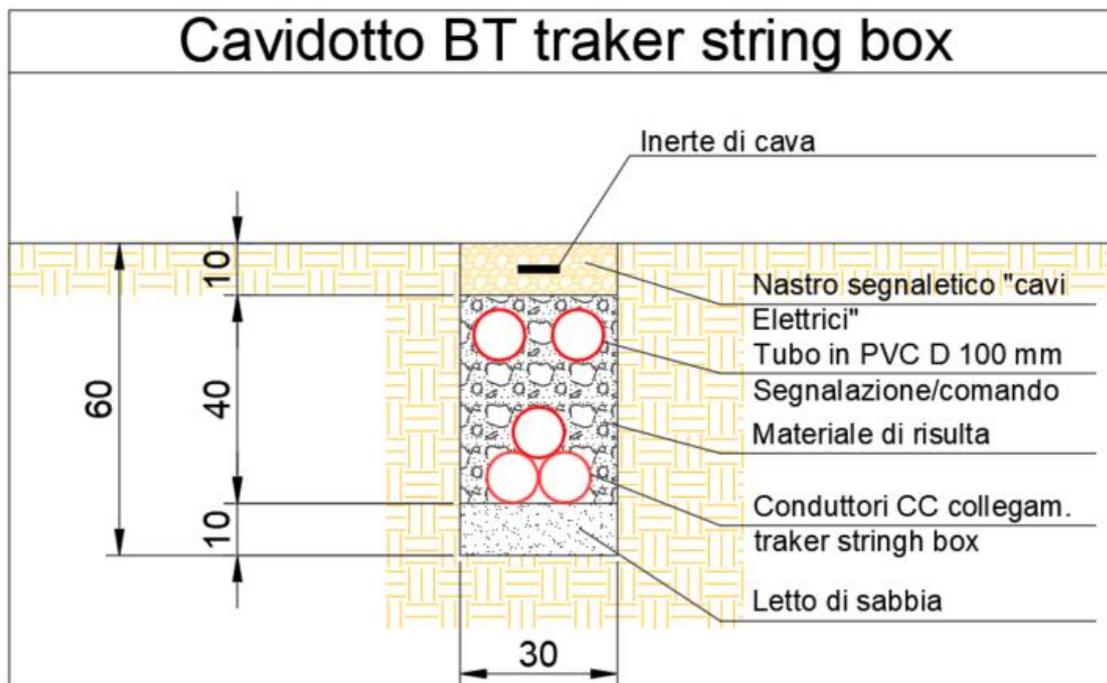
Sezione tipo cavidotto BT tracker – string box
